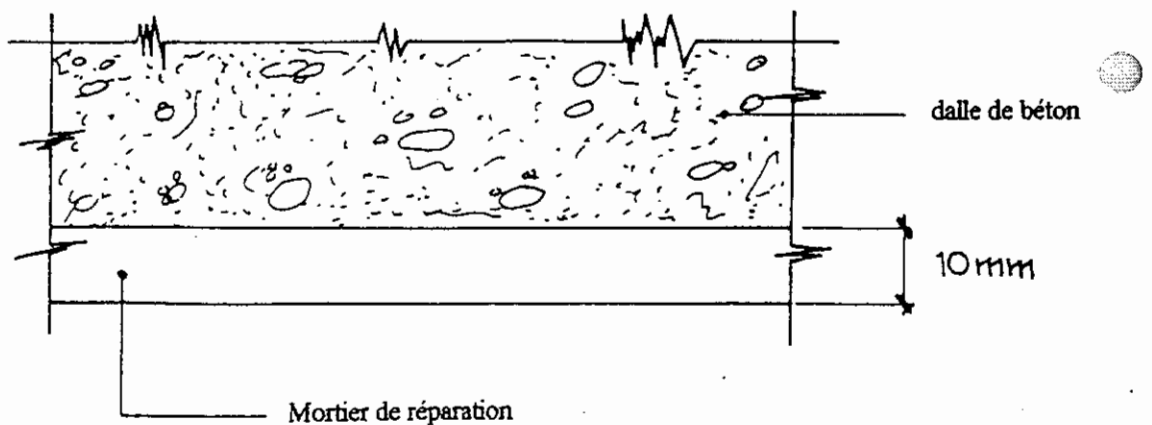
COUPE DANS LA DALLE - DETAIL
